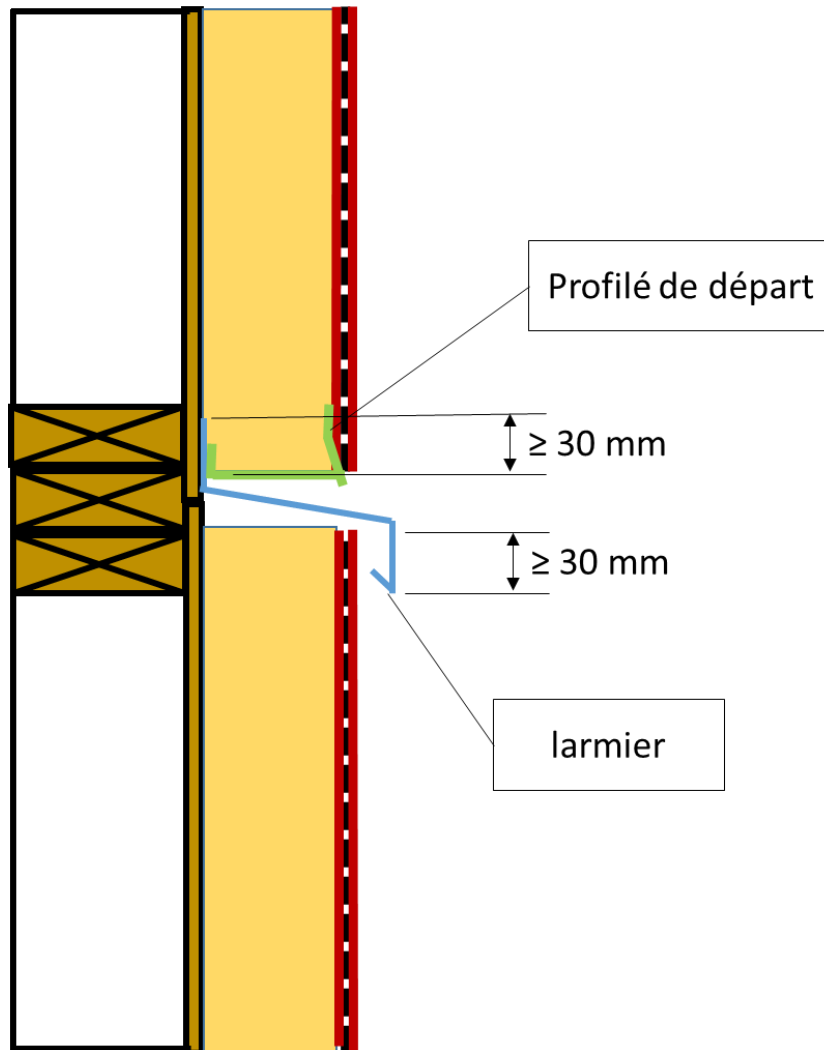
Exemple de raccord horizontal: avec bavette (coupe verticale)
